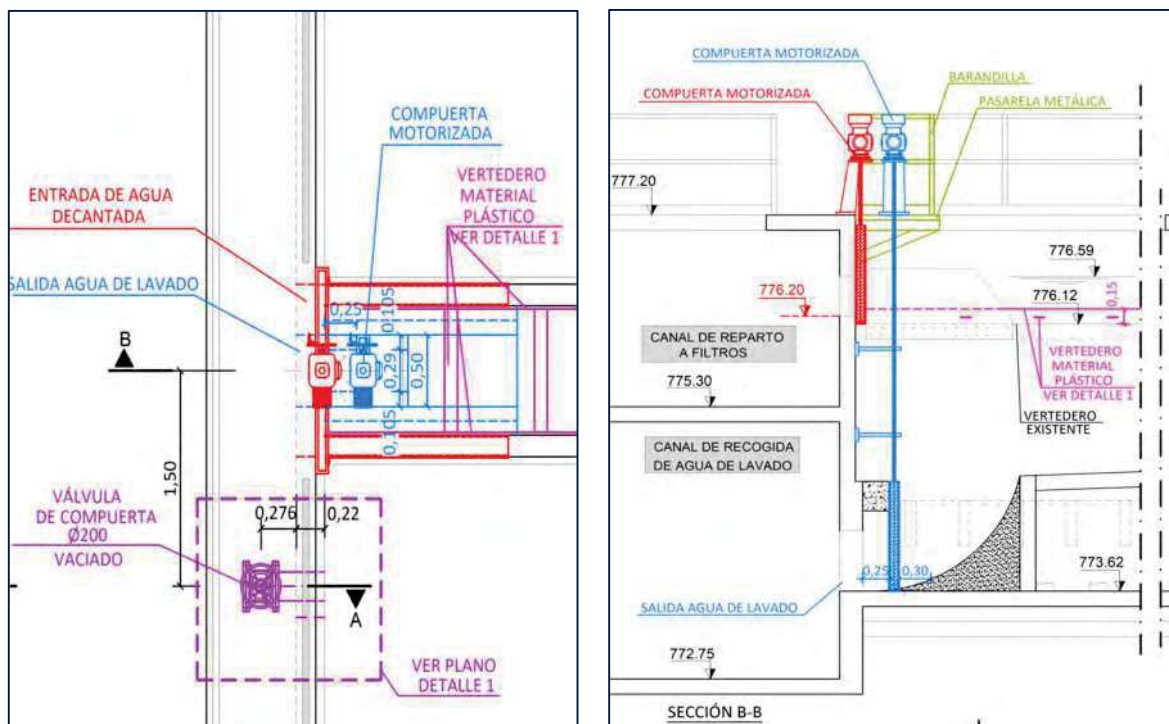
Planta y sección de compuertas motorizadas de entrada y agua de lavado en filtros.
